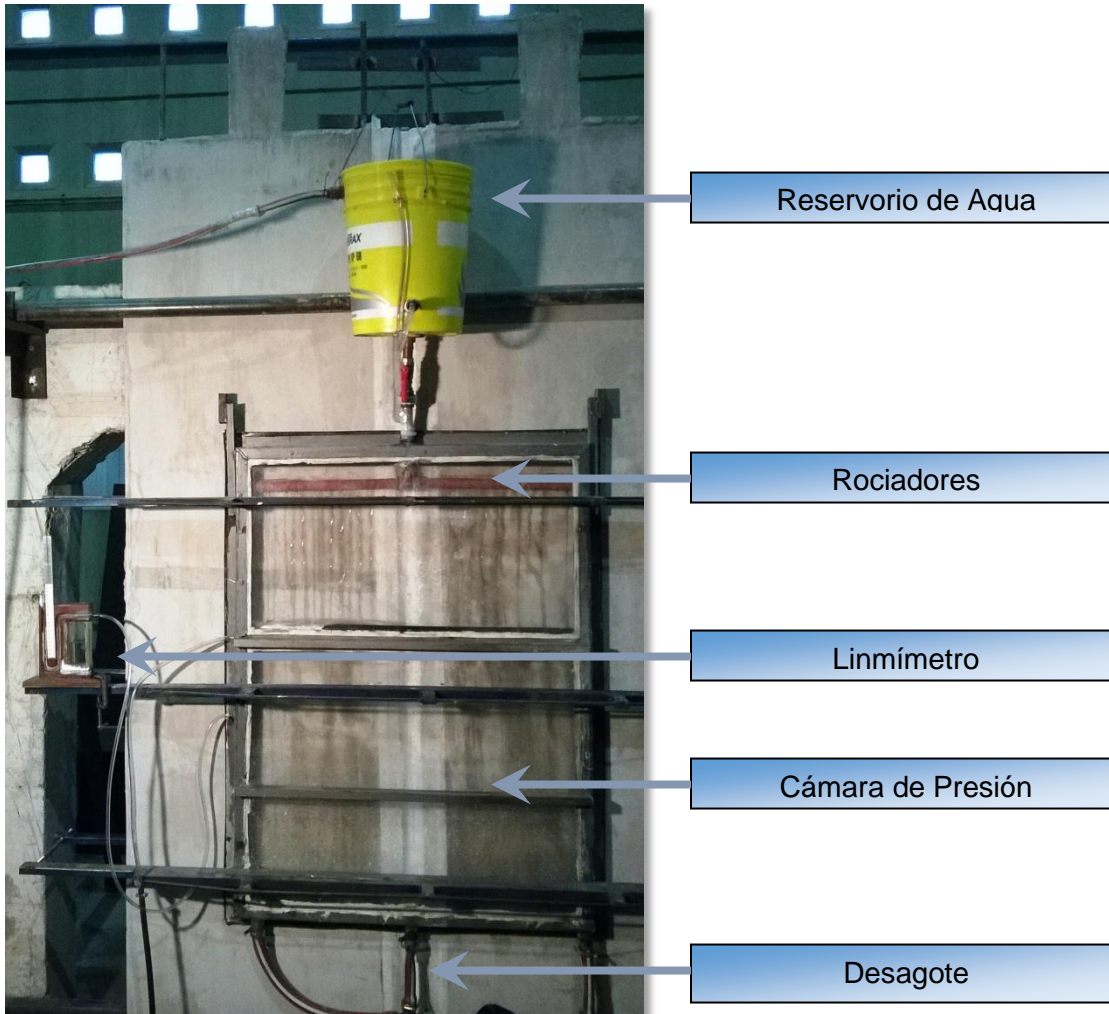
Detalle Dispositivo para Ensayo ASTM E – 514.
